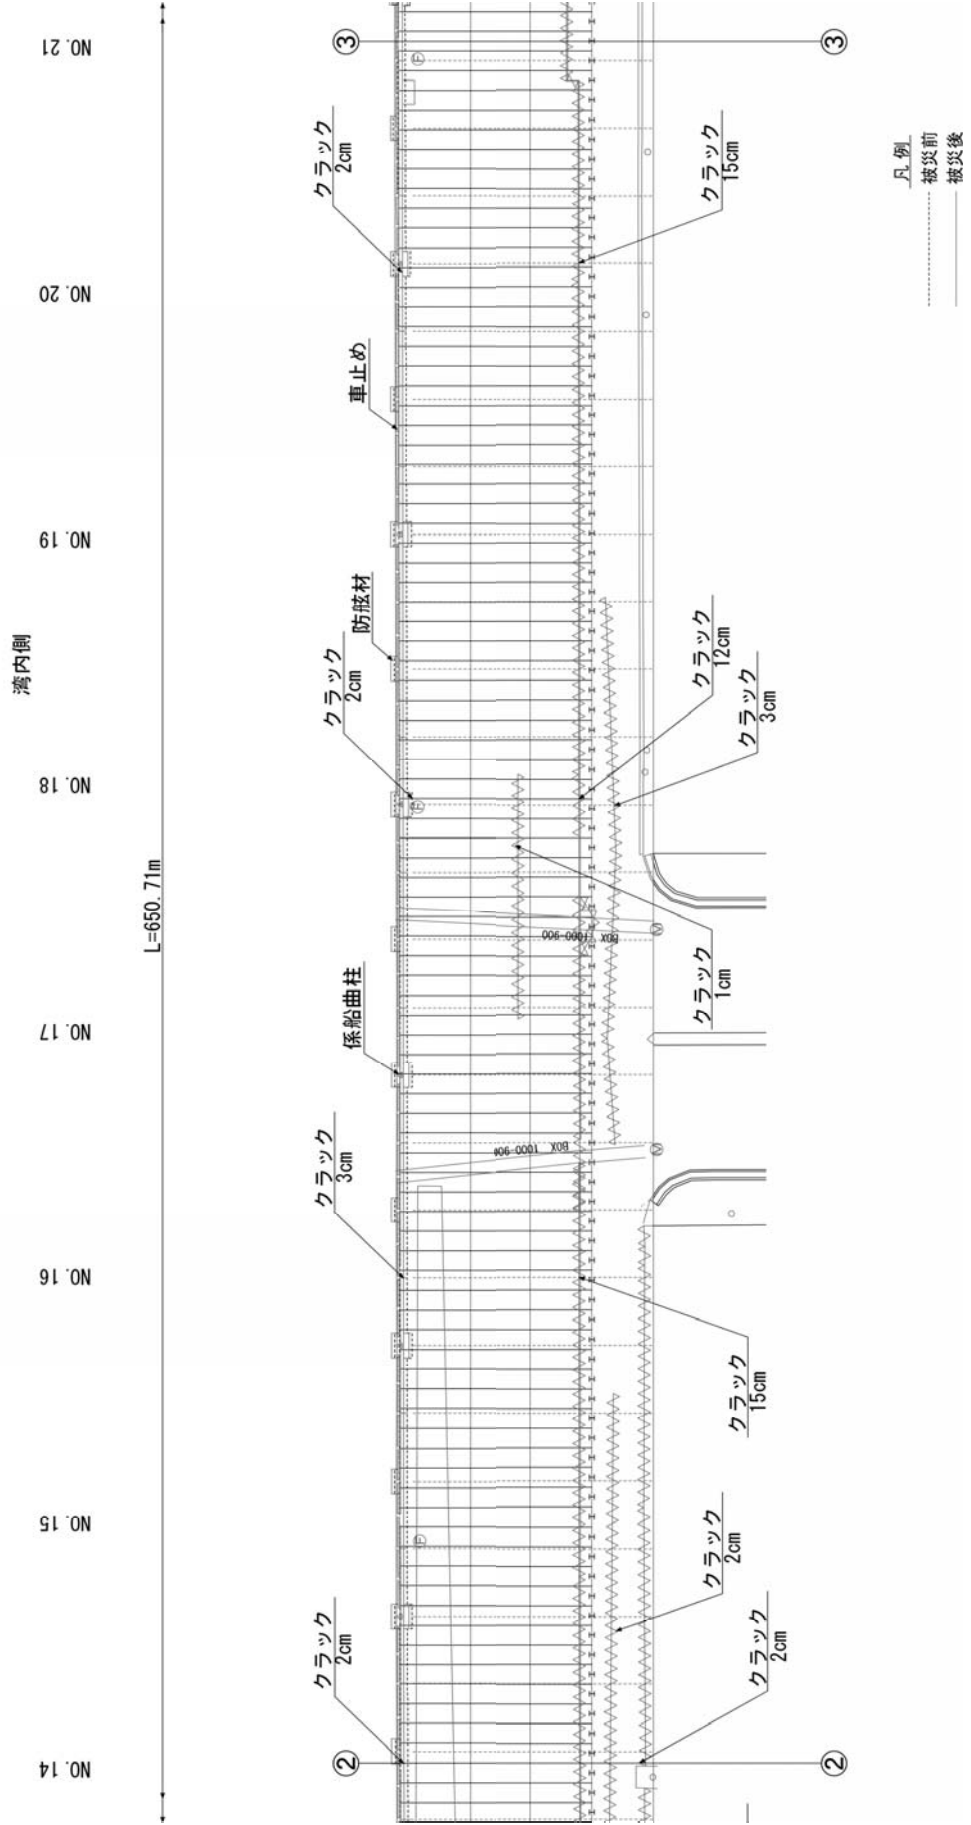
(a) 箱崎埠頭-7.5m 岸壁の被災状況詳細平面図
